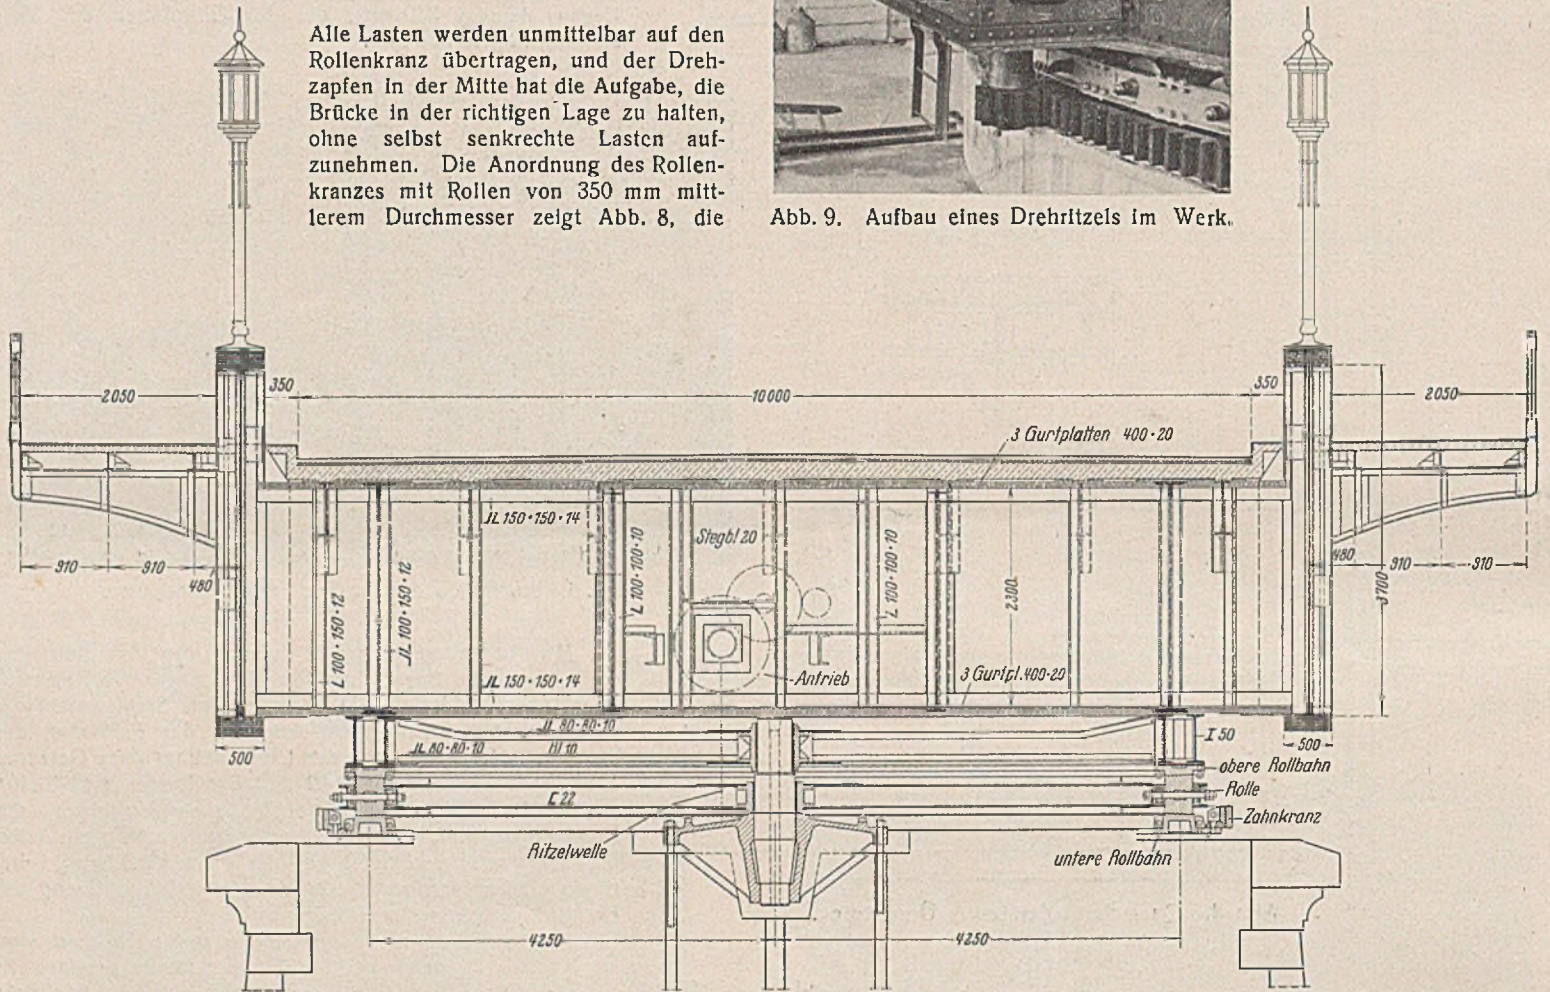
Querschnitt der Drehbrücke über dem Drehpfeiler.
